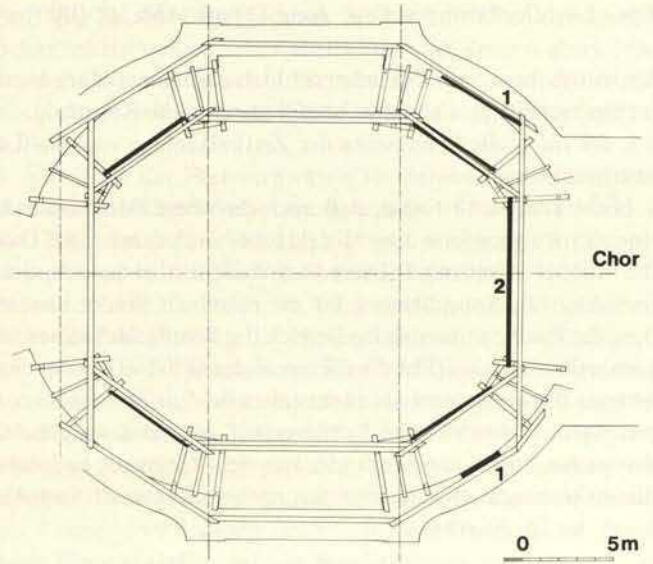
Grundriß der Zone A, Fachwerkgerüst mit darüberliegenden Schwellenkränzen; die zusätzlichen Bauglieder schwarz angelegt
